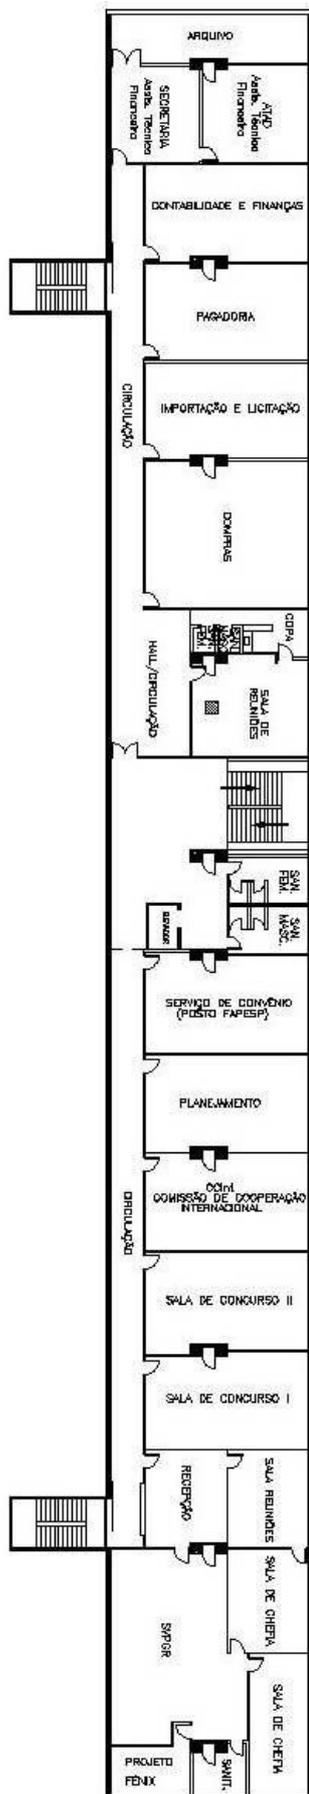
Planta 2º Pavimento – Bloco E1      Figura 42 – Planta 3º Pavimento – Bloco E1
